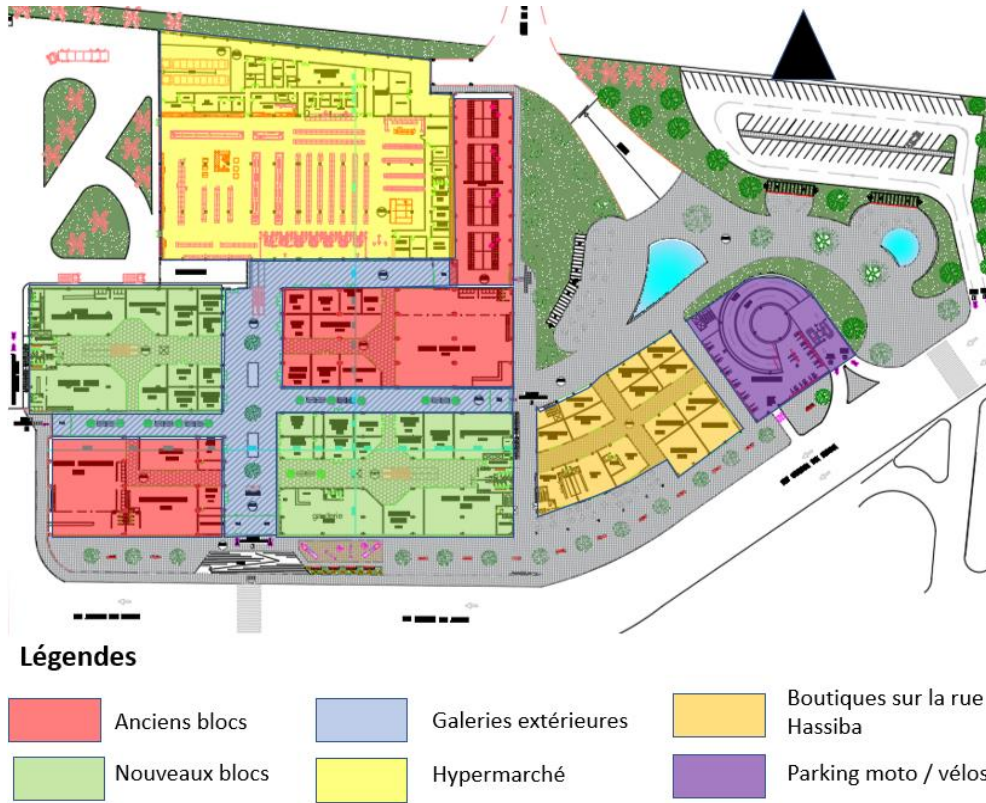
Plan du rez-de-chaussée. (Source : auteur)
